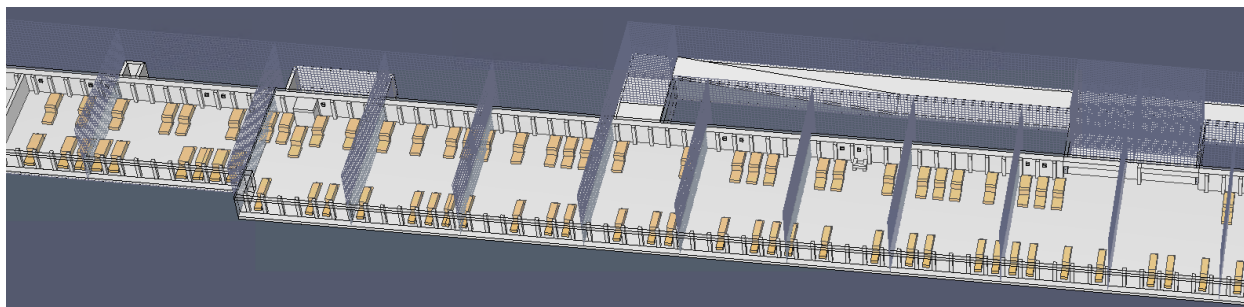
Exemple de la ubicació de cotxes del tram 1 de la planta PS-4
